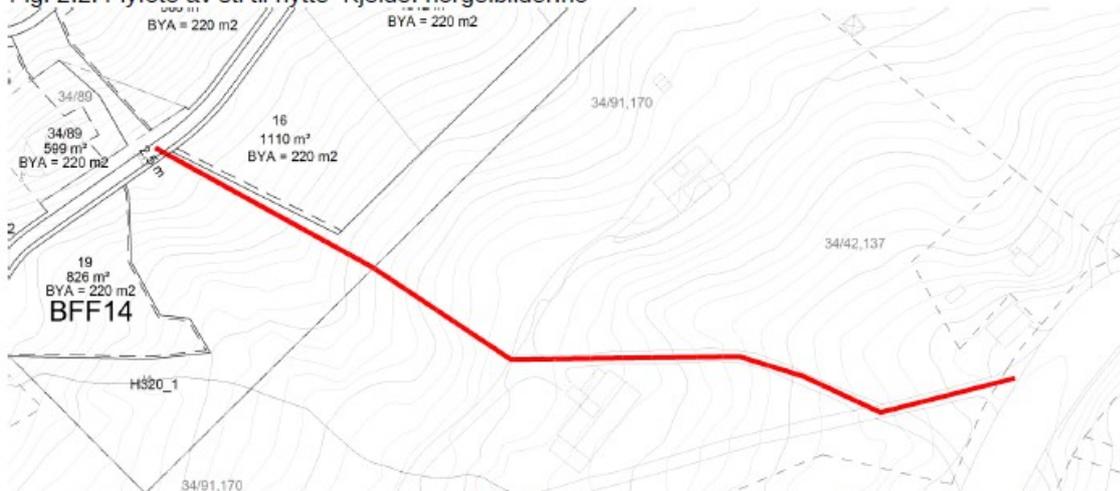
Utsnitt av planframlegg etter framlegg til justering av tomt 16. Raudline viser tilkomststi.
